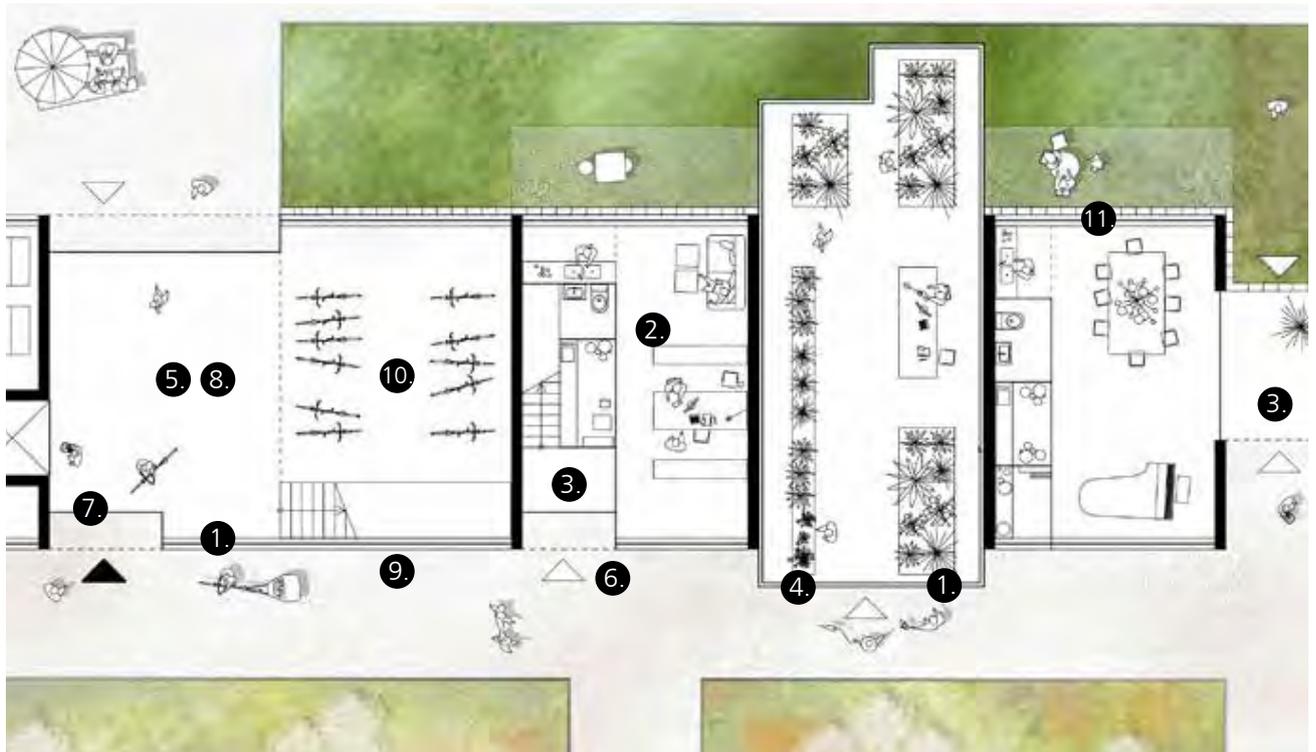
Schematischer Grundriss 1:200: Erdgeschossschnittstelle zwischen Römerstraße (Westseite) und Innenhof
